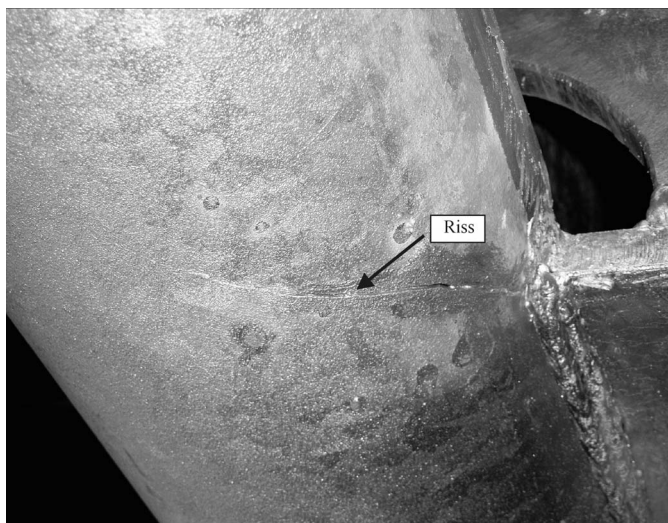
Detail aus Bild 2 (Foto: Institut für Stahlbau Leipzig)
